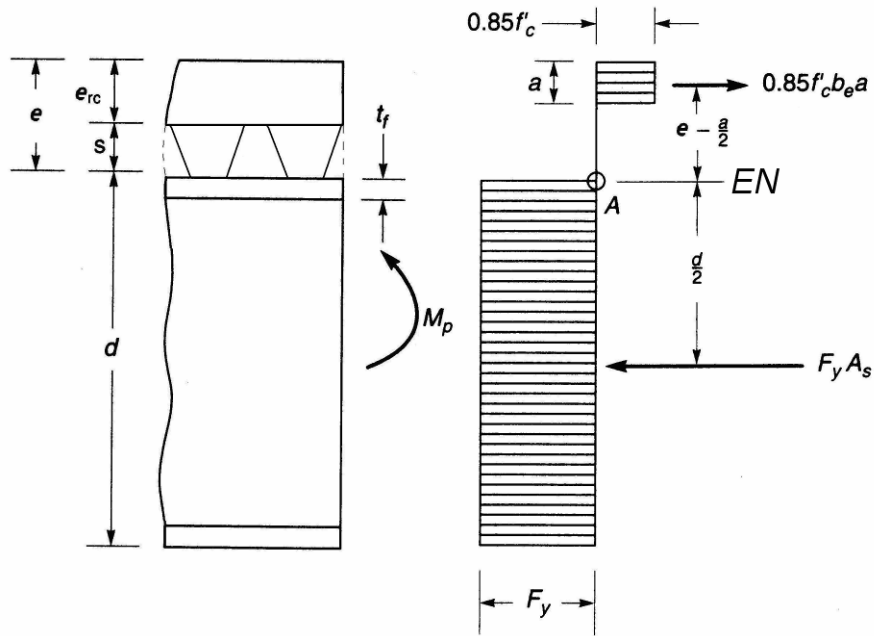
Sección transversal compuesta para análisis plástico.
